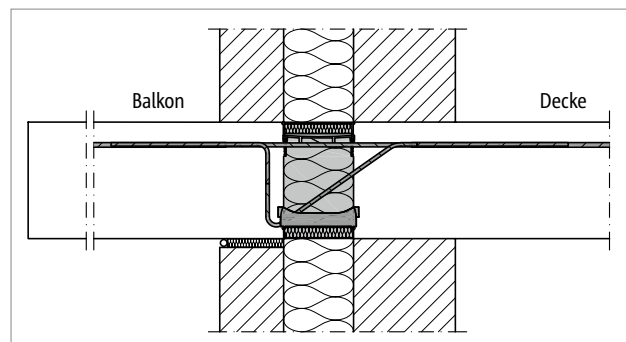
Schöck Isokorb® XT Typ KL: Anschluss bei zweischaligem Mauerwerk mit Kerndämmung
